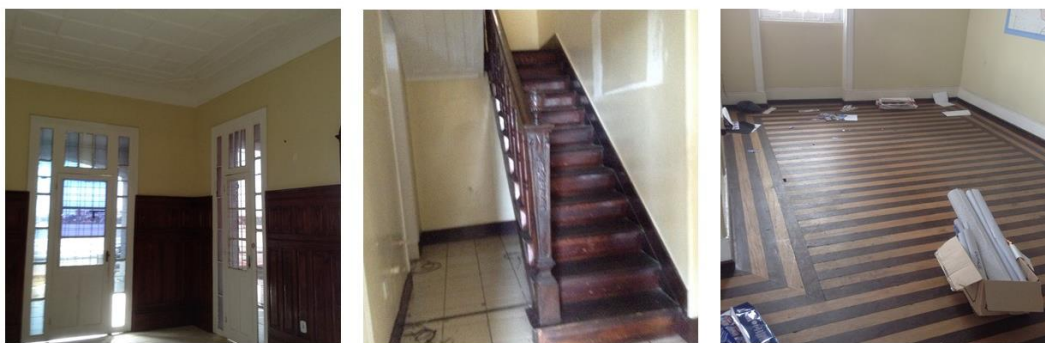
Vista interna da Residência Nº 480: sala de estar com lambri nas paredes e escada em madeira no pavimento térreo; piso madeirado do pavimento superior. Fonte: autora, 2018.
